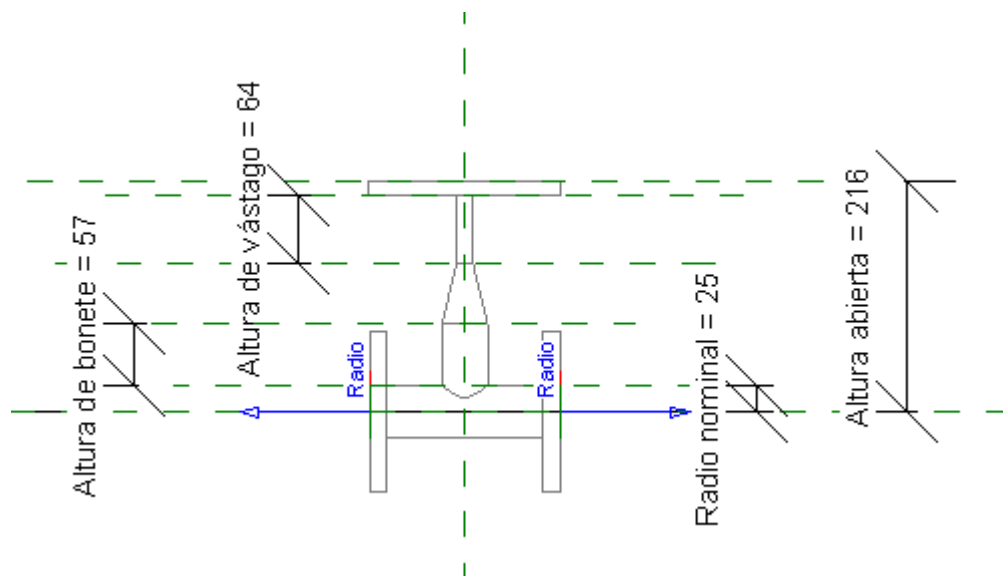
Alzado válvula de compuerta biblioteca Revit
